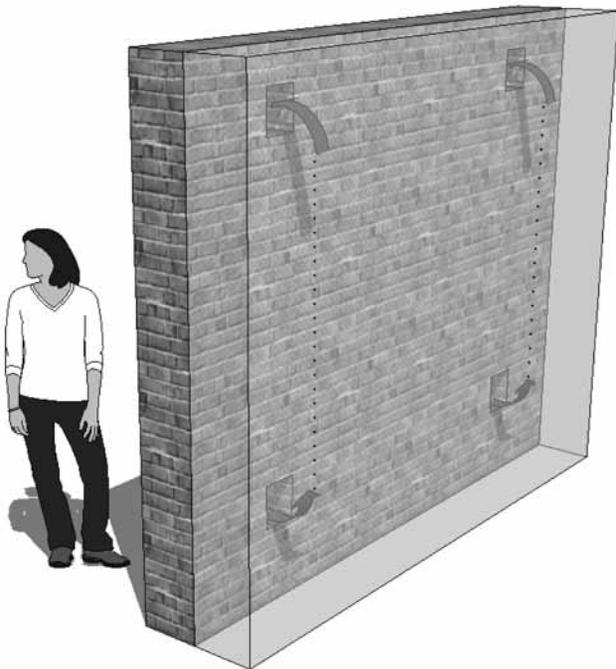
Efecto stack en fachada ventilada de ladrillos. Fuente: elaboración propia
